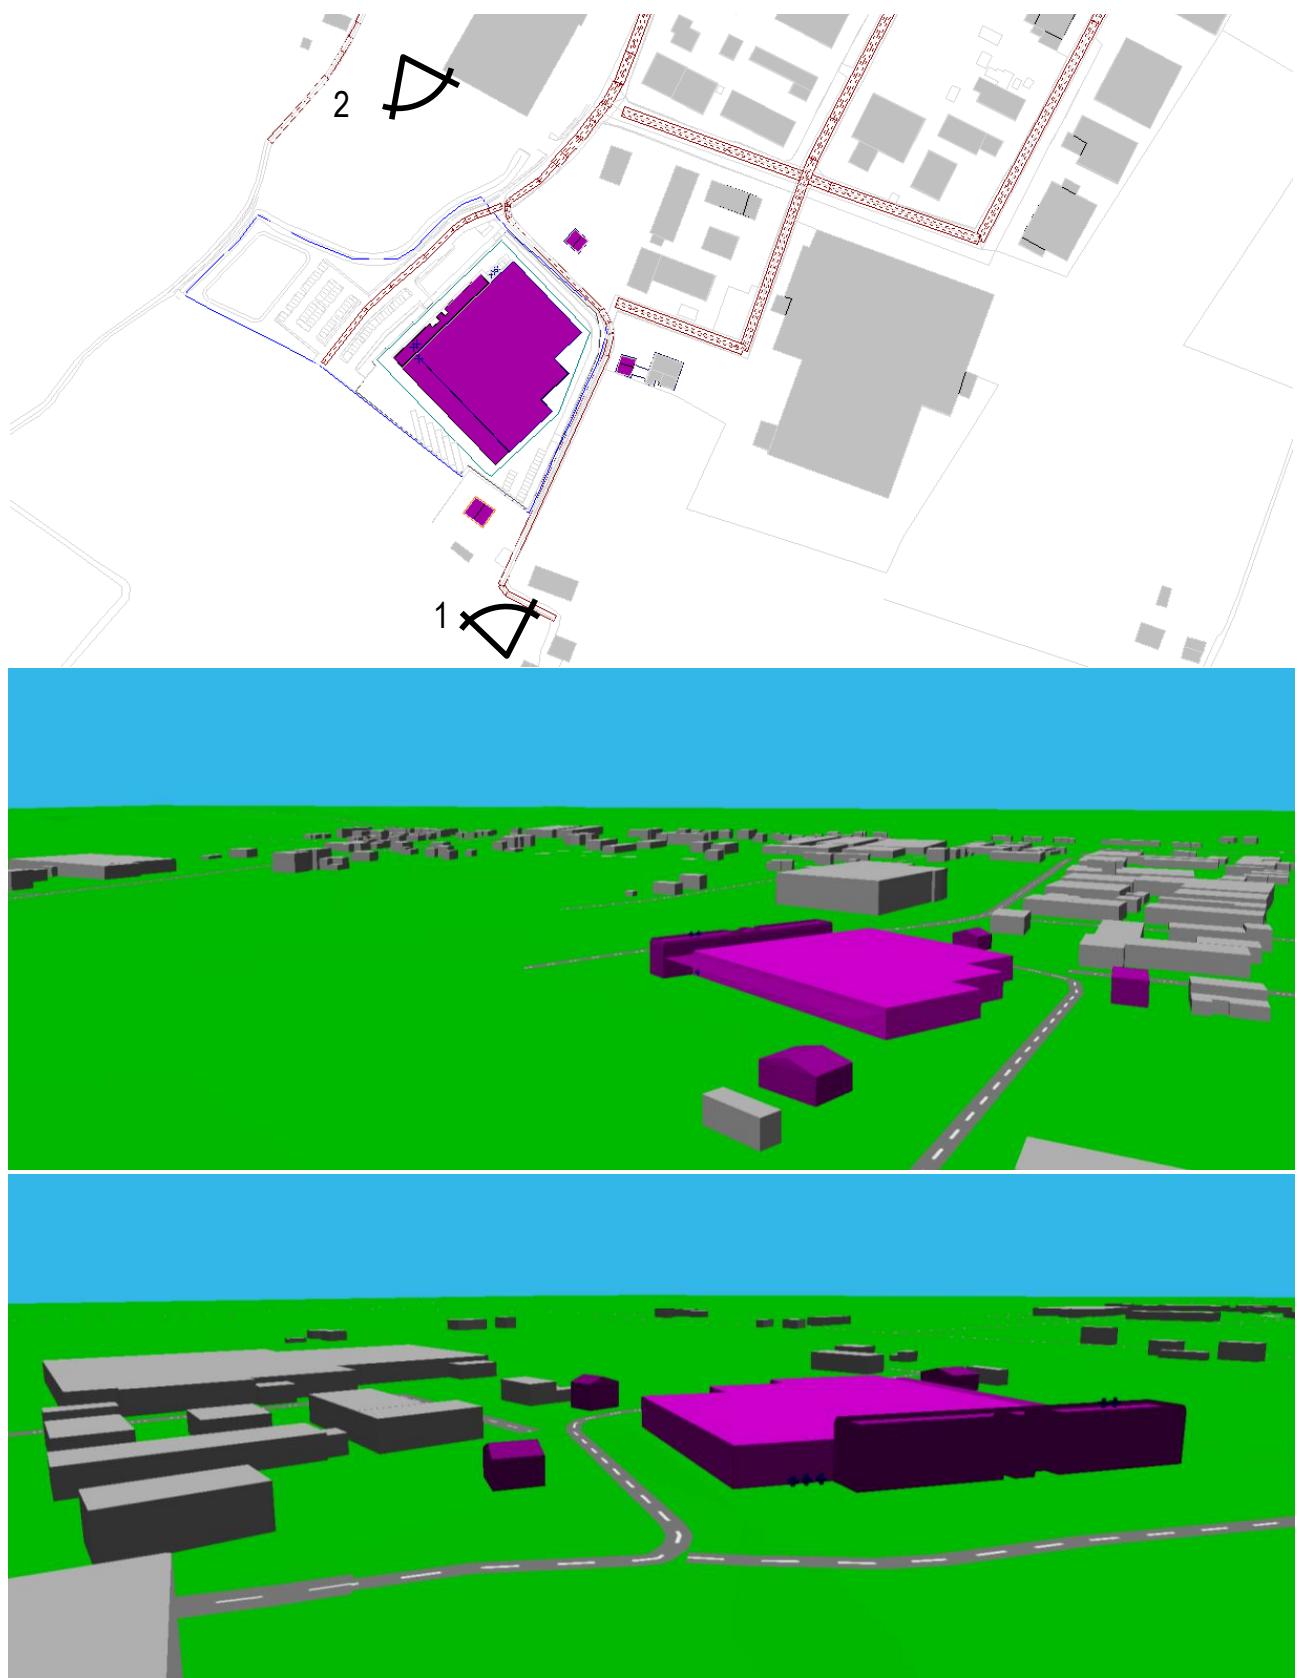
Rappresentazione in pianta e vista 3D (vista 1 sopra e vista 2 sotto) dello stato di progetto senza il completamento della nuova Bretella di collegamento.
